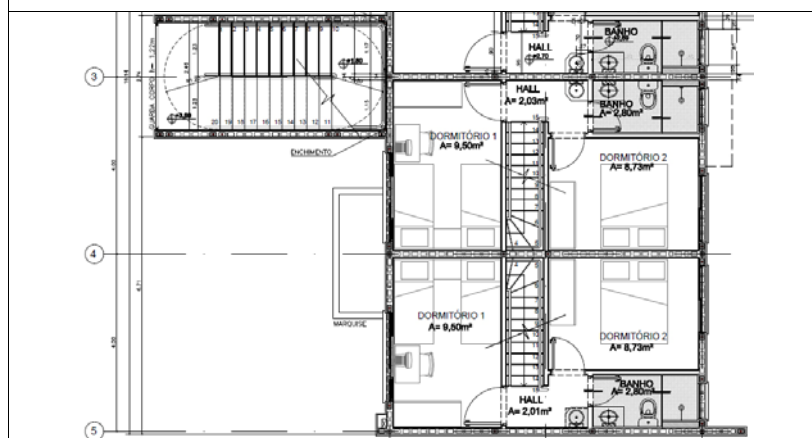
Planta 1º pavimento Edifício SB22. Fonte: CDHU (2012)
